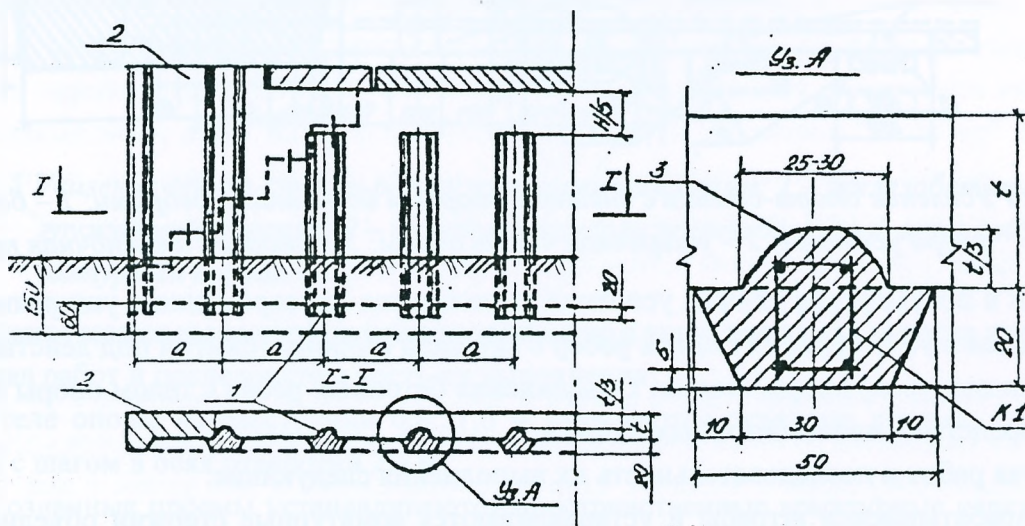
Усиление опоры-стенки с внутренней стороны железобетонными ребрами: 1 – железобетонные ребра усиления; 2 – уширенная часть опоры; 3 – канал в существующем теле опоры.
